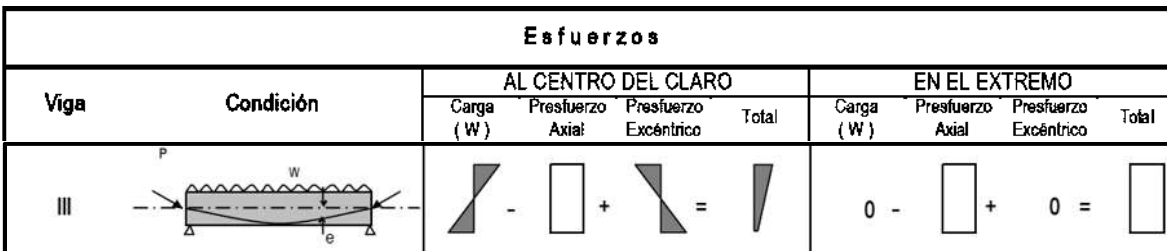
Esfuerzos al centro de claro y en el extremo de vigas simplemente apoyadas con presfuerzo con excentricidad variable, [SEPSA S.A. de C.V.]
